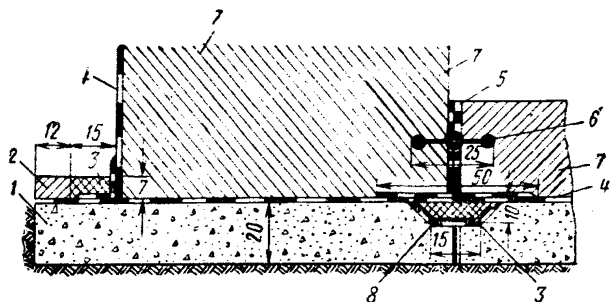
Сопряжения холодной асфальтовой гидроизоляции основания сооружения со швами и гидроизоляцией стен
